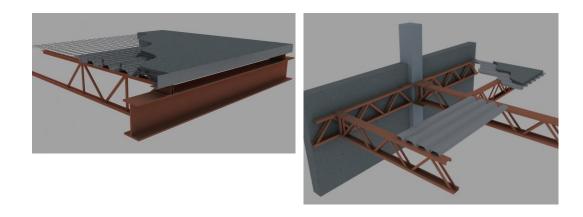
Detalle Losa Colaborante para Salas de Convenciones.
